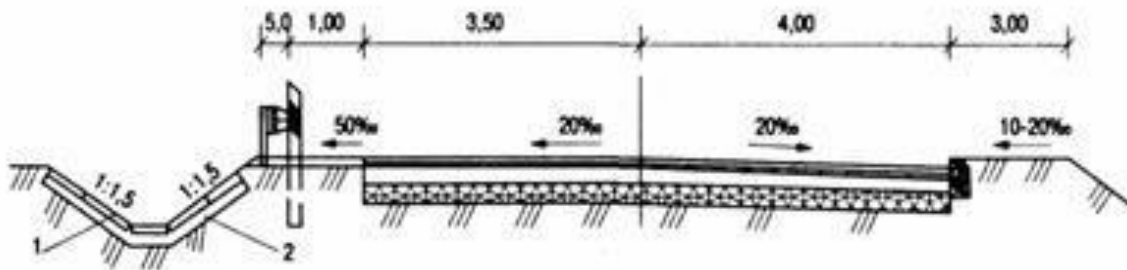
Система організації поверхнового водоотвода на автомобільній дорозі Будапешт – Геделе в Венгрії (1980 г): 1 - бетонна плитка 10.60.10 см; 2 - бетонна подушка
